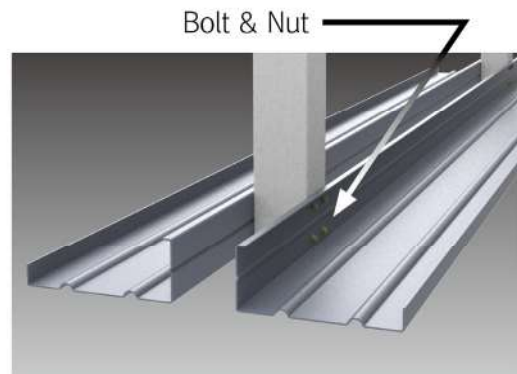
플로어 빔(Floor Beam)과 지주(Column)의 접속
